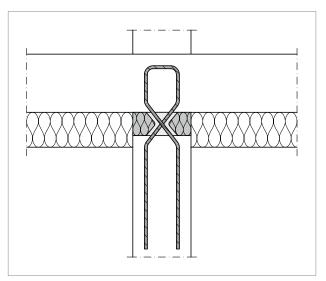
Schöck Sconnex® type W-N-VH : coupe B-B, mur intérieur ; isolation sous la dalle
